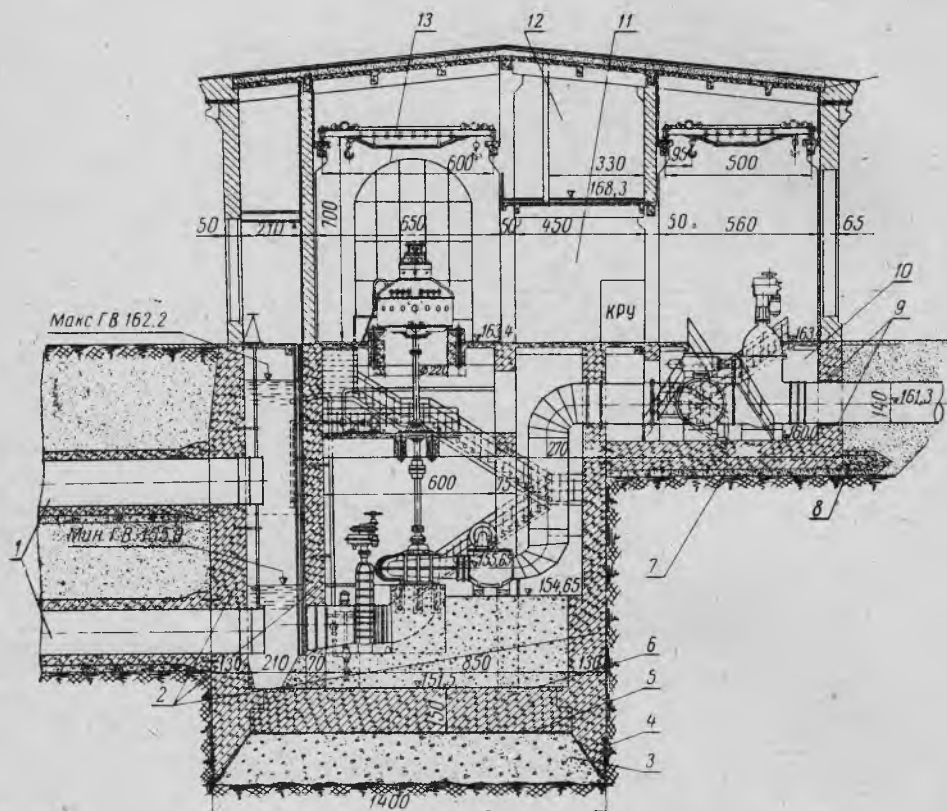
Подземная часть здания насосной станции, выполненная железобетонным опускным колодцем:
